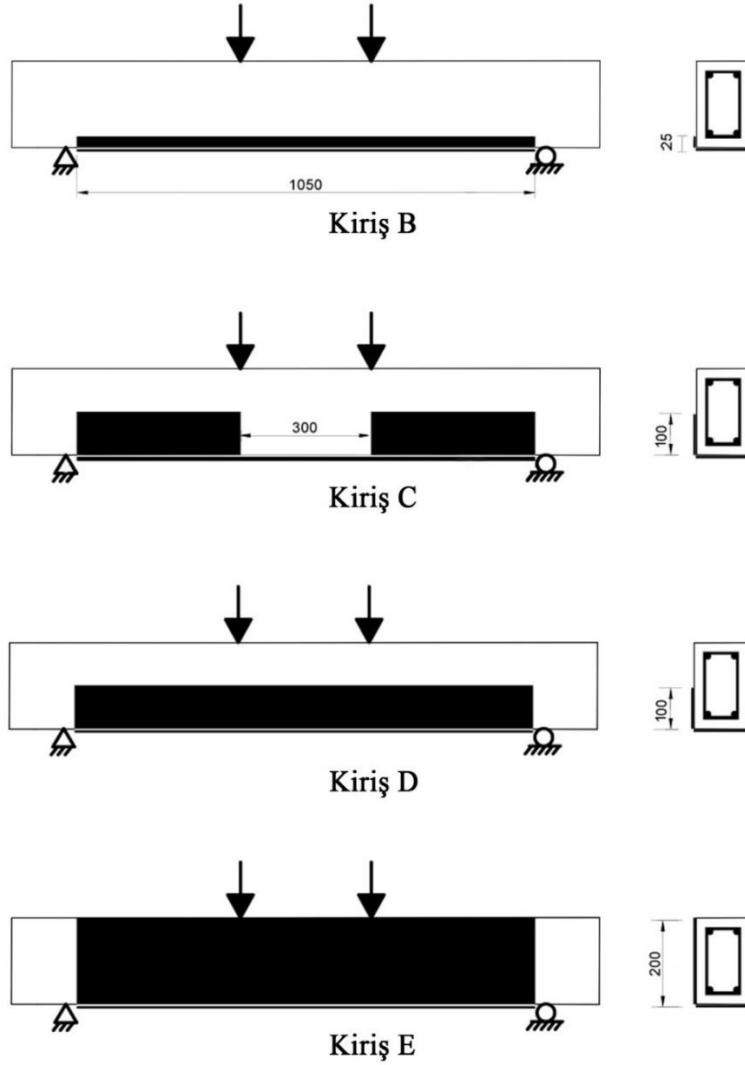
Deney çalışmasında kullanılan kiriş detayı
